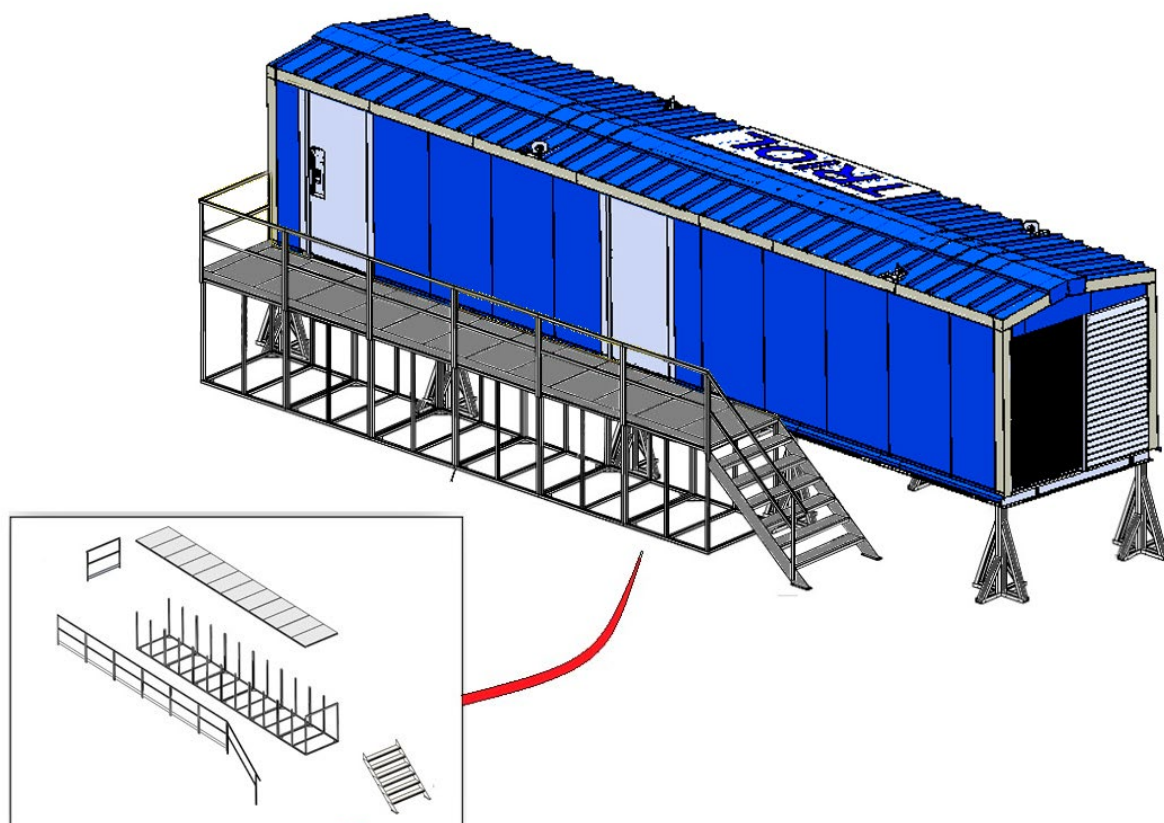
Монтаж помоста, установка ограждающих конструкций, лестницы и верхних площадок
